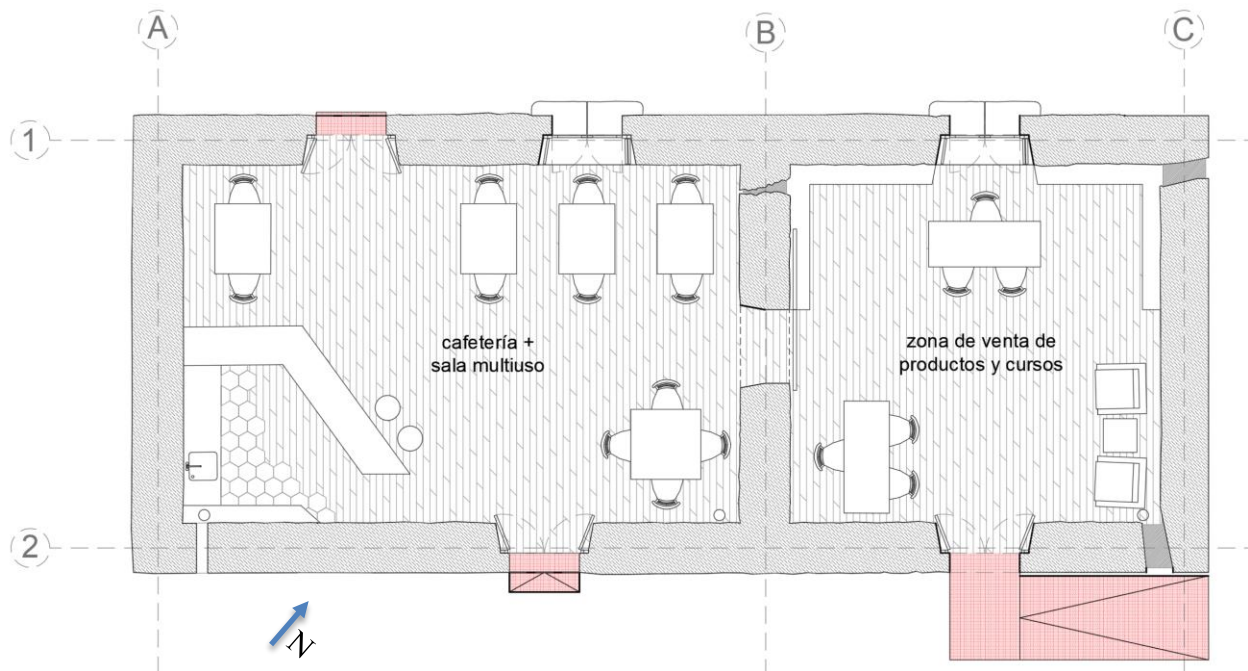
Planta casa de piedra, sin escala. Elaboración propia
